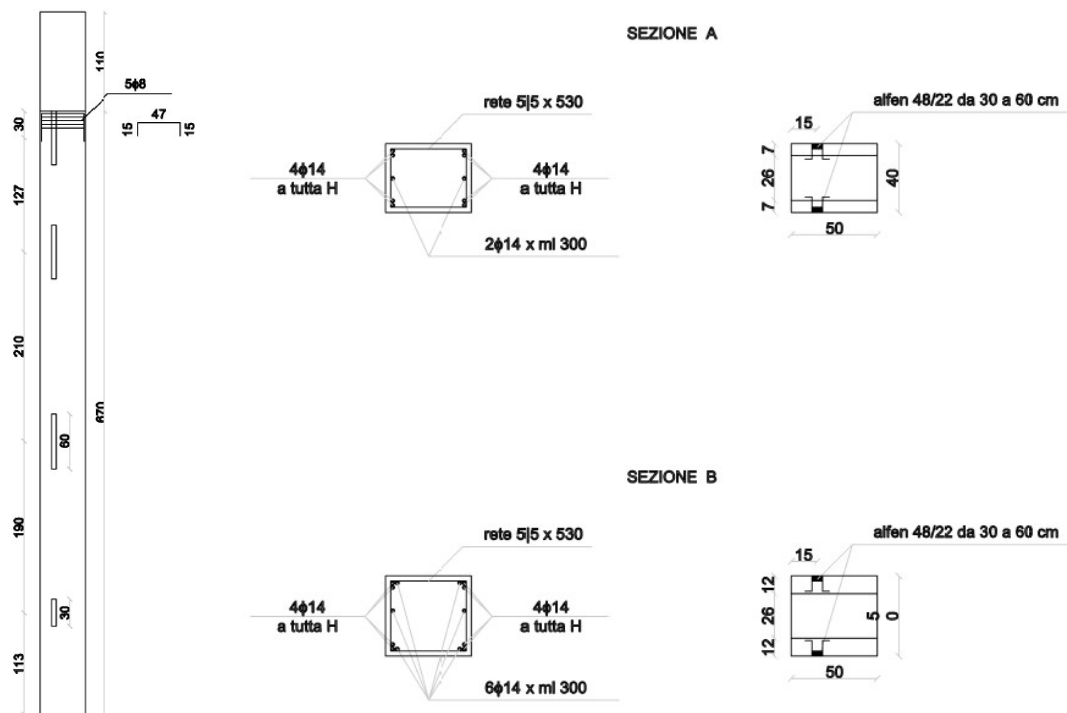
Stralcio del progetto originale contenete prospetto e sezione dei pilastri
